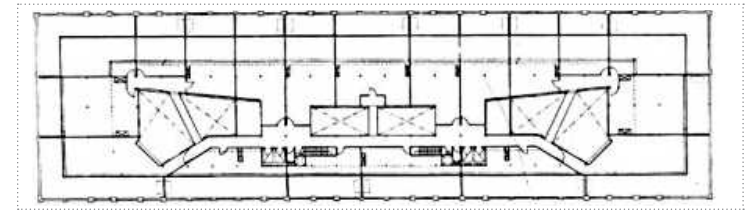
Planta 4º pavimento do Galpão 5, onde se distribuem as unidades habitacionais duplex. Fonte: Revista Arquis nº 1.
